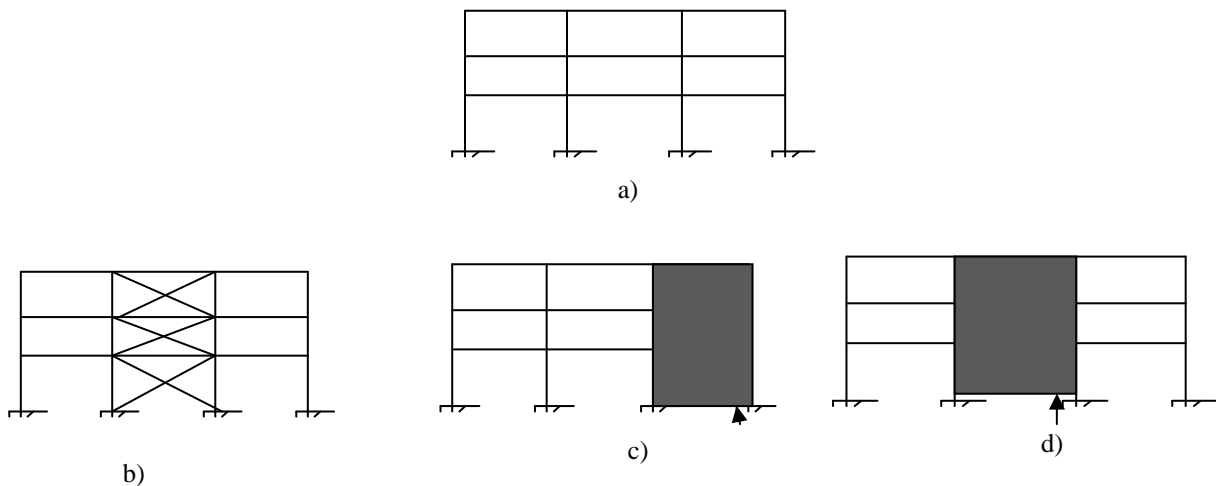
Structure de bâtiment avec un système de contreventée ; a) structure non contreventée, b) Palées de stabilité, c) Voile en B.A, d) Noyau central.
